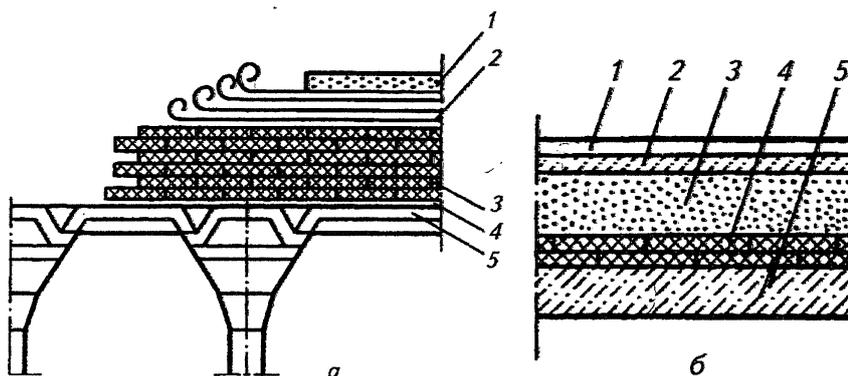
Изоляционные конструкции покрытий холодильника:
